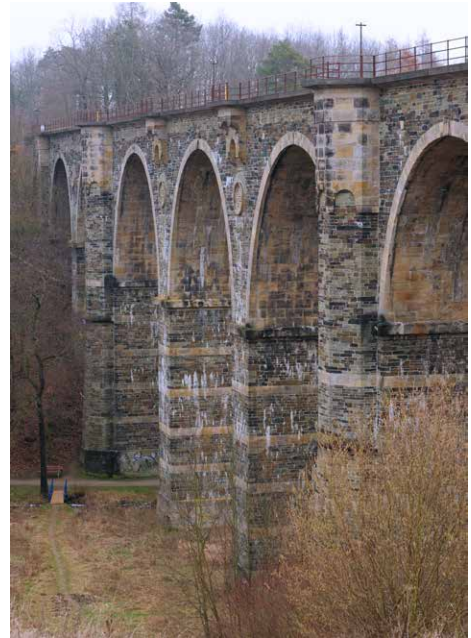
| Plauen: Syratalbrücke der Eisenbahnstrecke Plauen–Schönberg–Cheb/Eger, Schichtmauerwerk mit Diabas-
